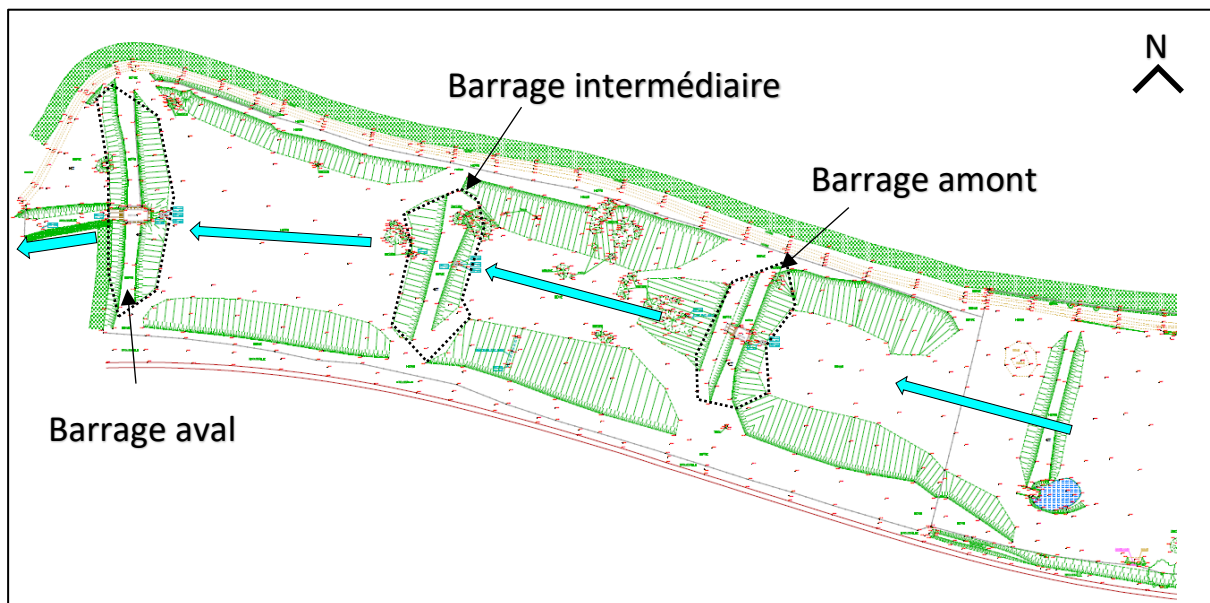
Vue en plan des bassins de la STEP d'Etretat et photographies.
